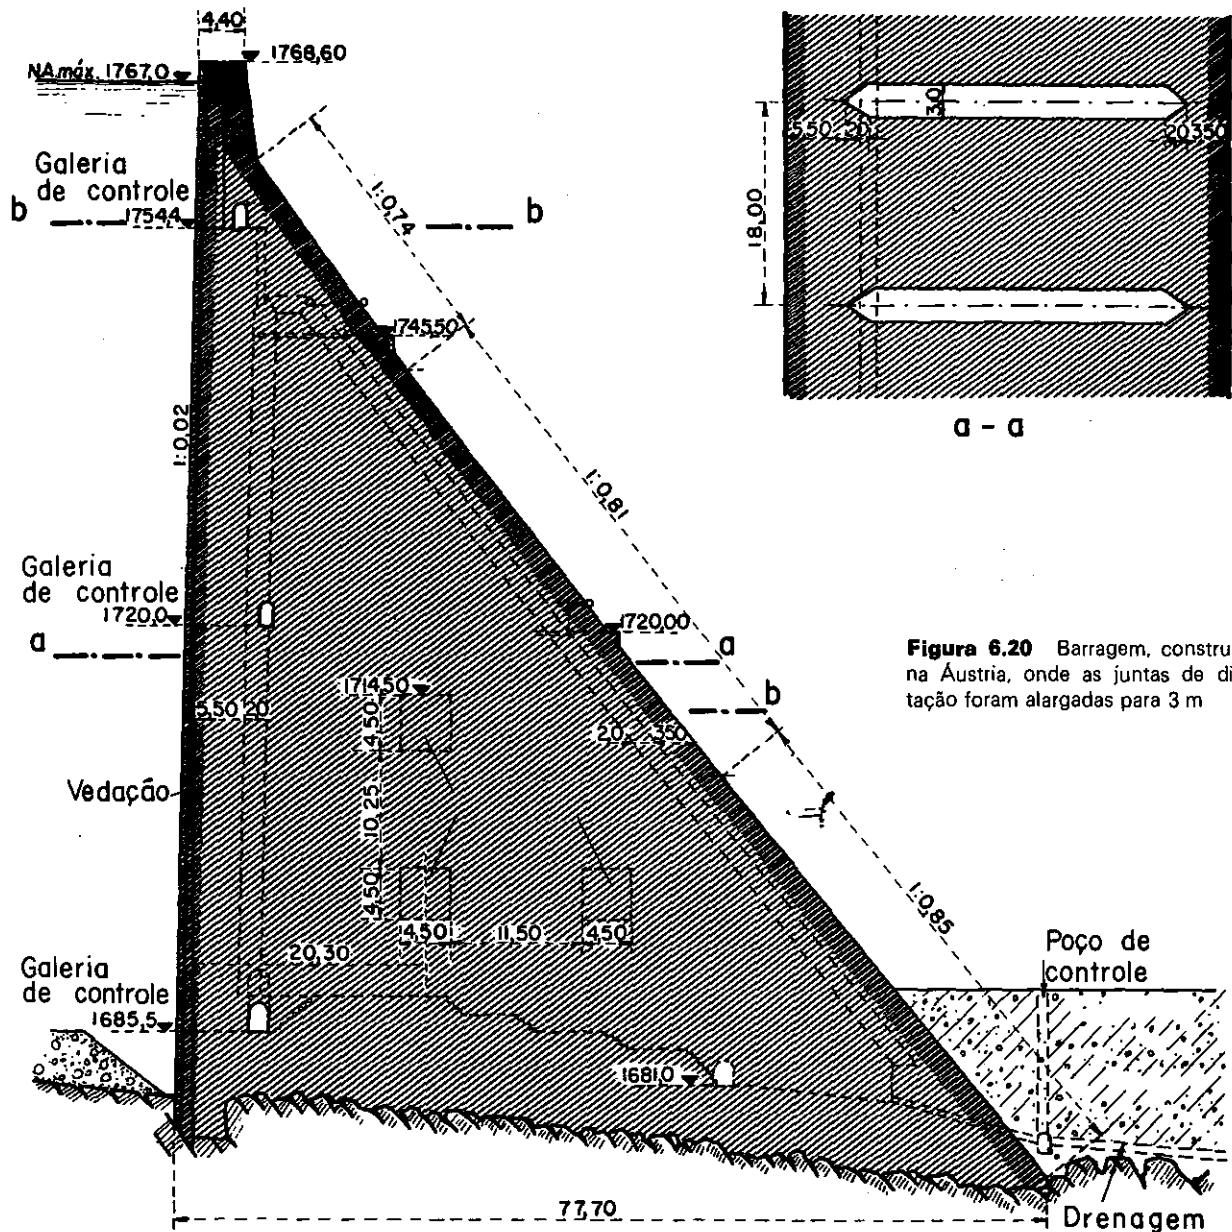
Barragem, construída na Áustria, onde as juntas de dilatação foram alargadas para 3 m
